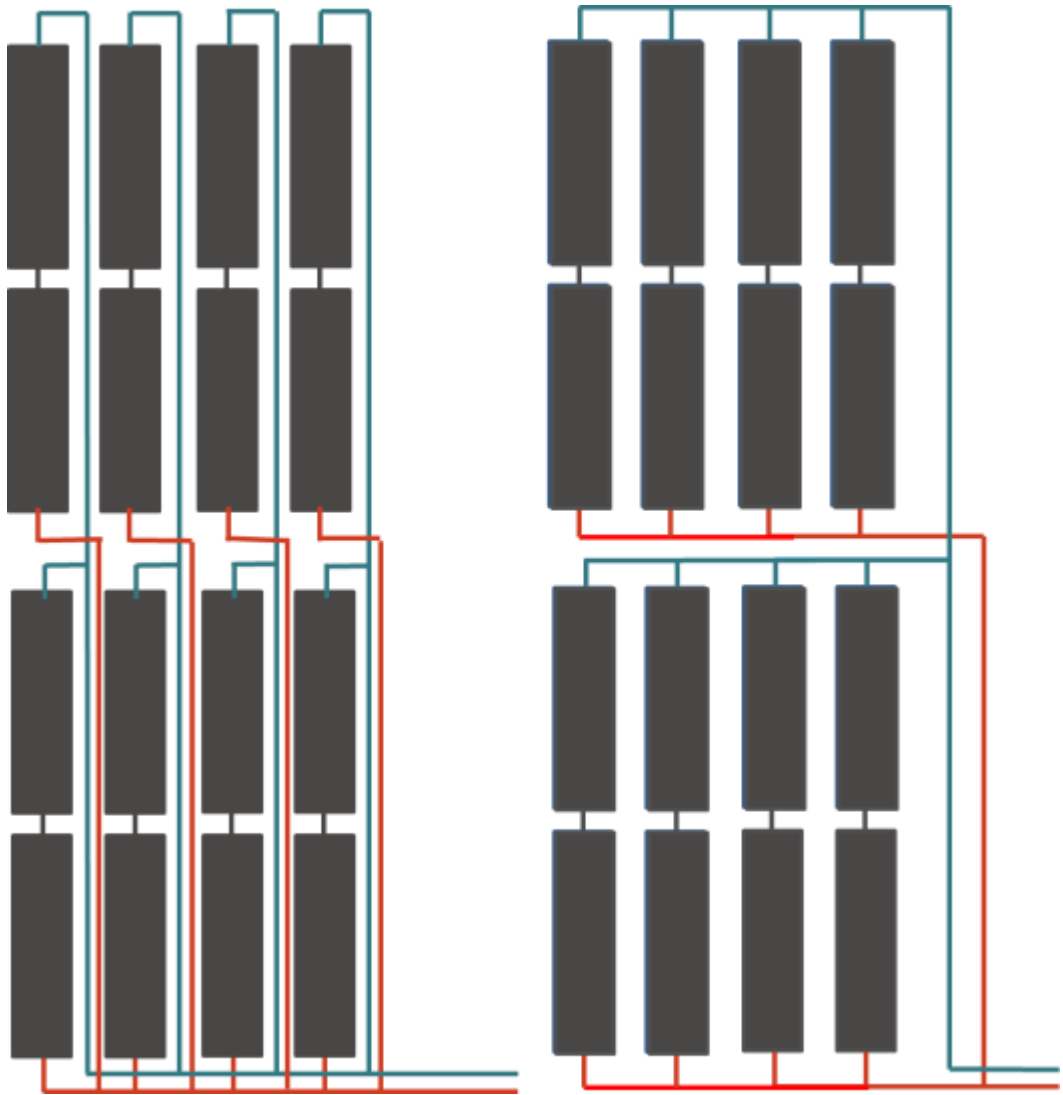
Conexión en baterías en horizontal (esquema derecha) y conexión de baterías en vertical (esquema izquierda)
